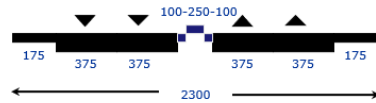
SEZIONE STRADALE TIPO B
